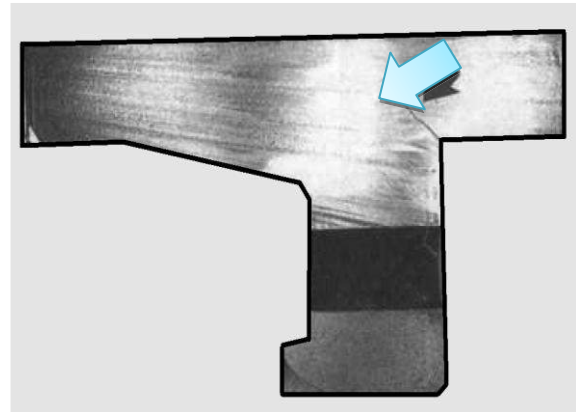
Frattura in corrispondenza della sporgenza della flangia
